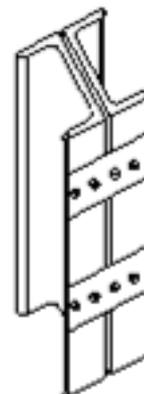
Konstruksi Bangunan Yang Ditinjau
